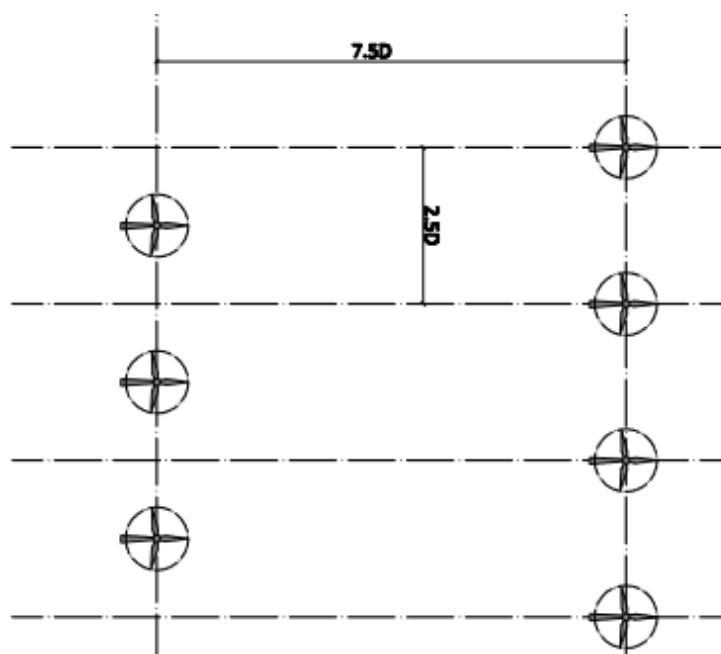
Disposición en planta de los Aerogeneradores. Fuente: Elaboración propia.
